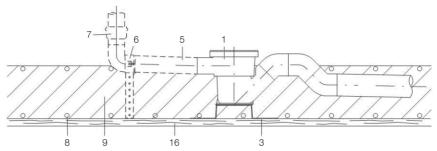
Pose dans la dalle en béton, montée sur coffrage
